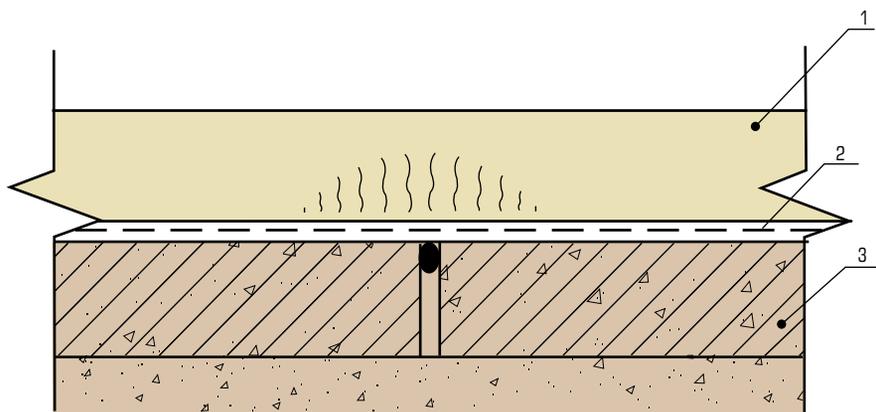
Схема укладки геосетки SamiGrid при усилении цементобетонных покрытий асфальтобетоном:
